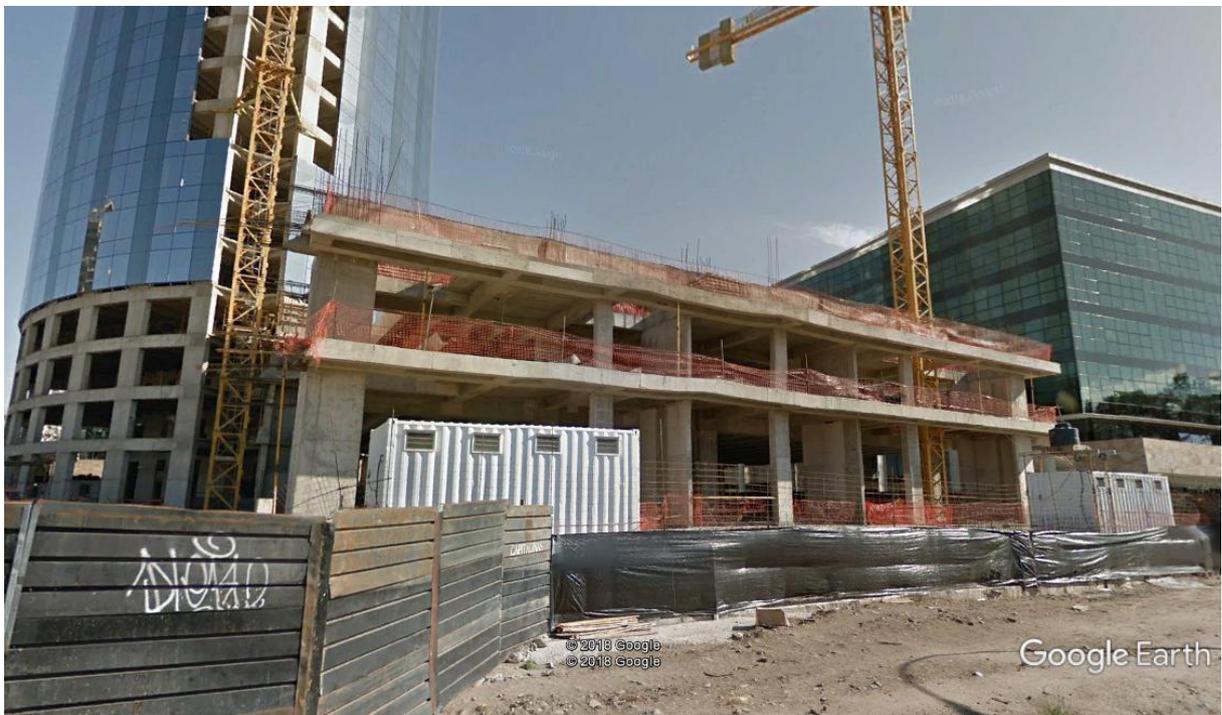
Otra vista parcial del Complejo “Capitalinas”. Fuente: Google Earth – Street View (2018)
